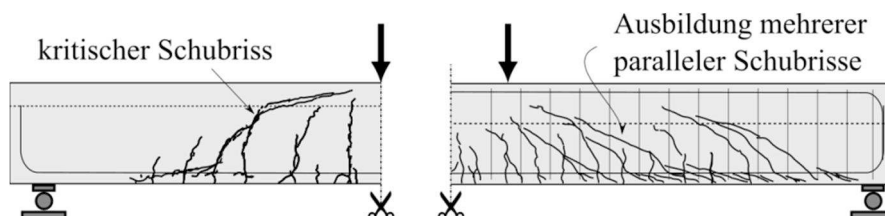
Rissbild im Bruchzustand bei Bauteil mit und ohne Querkraftbewehrung [1]
